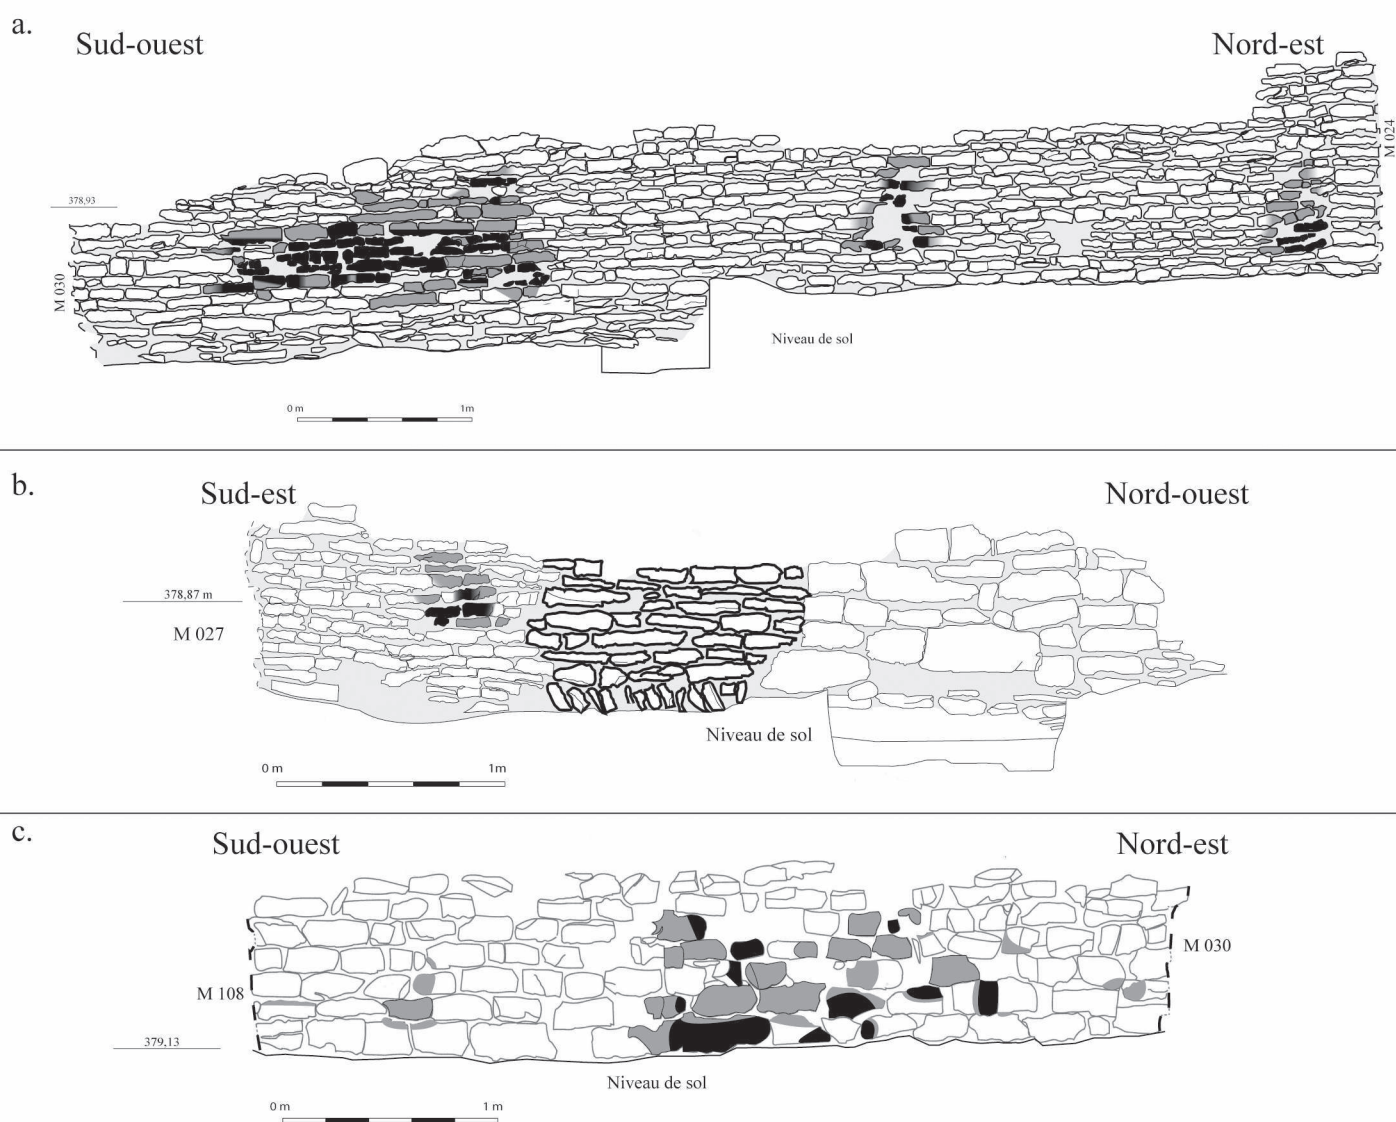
Types de murs du bâtiment 1 et traces de chauffe ; plus la couleur est foncée, plus la pierre est altérée.
